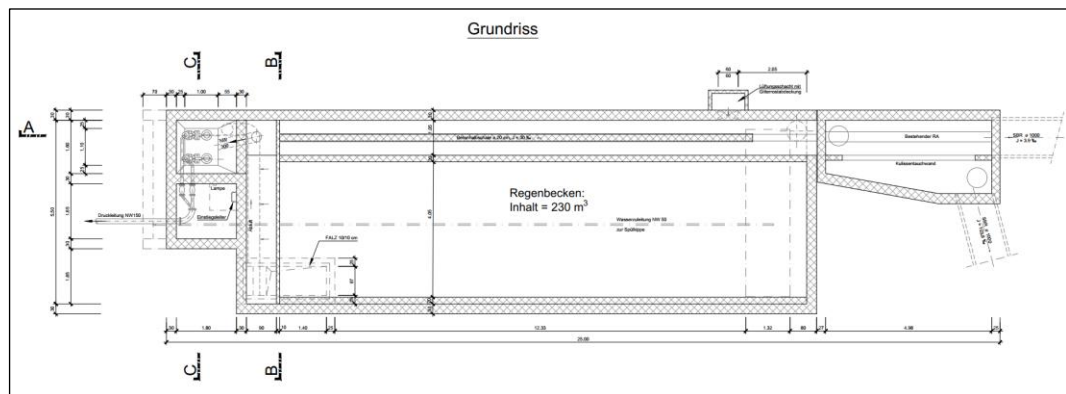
Grundriss vom Bauwerksplan
